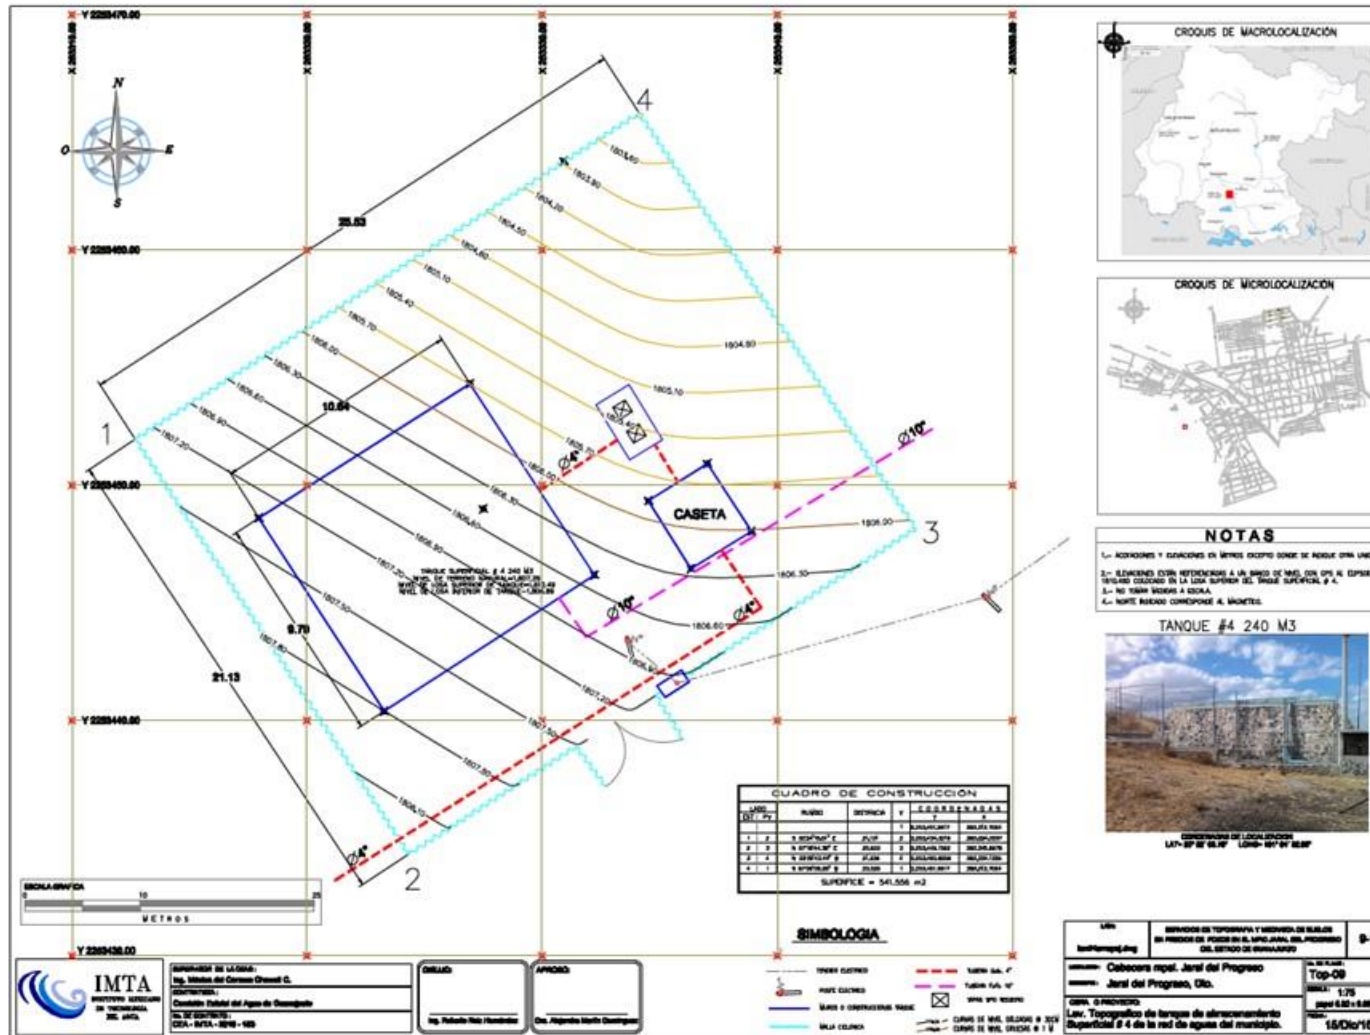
Levantamiento Tanque Santa Elena (Ver anexo de planos para más detalle)
